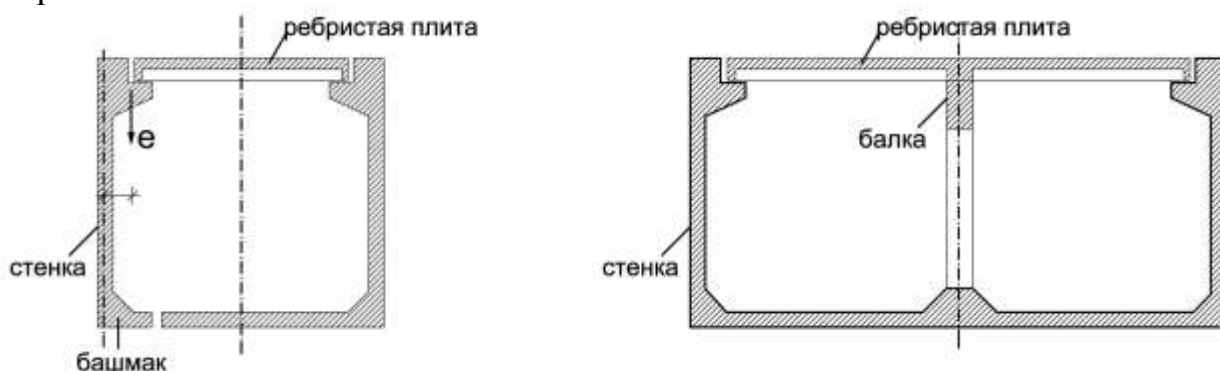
Поперечное сечение сборно-монолитных тоннелей с ребристым перекрытием
